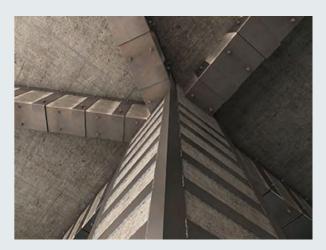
Ejemplo de encamisado con armadura de ángulos y soleras, con y sin conectores. Fuente: Horse Construction Company China, www.horseen.com
